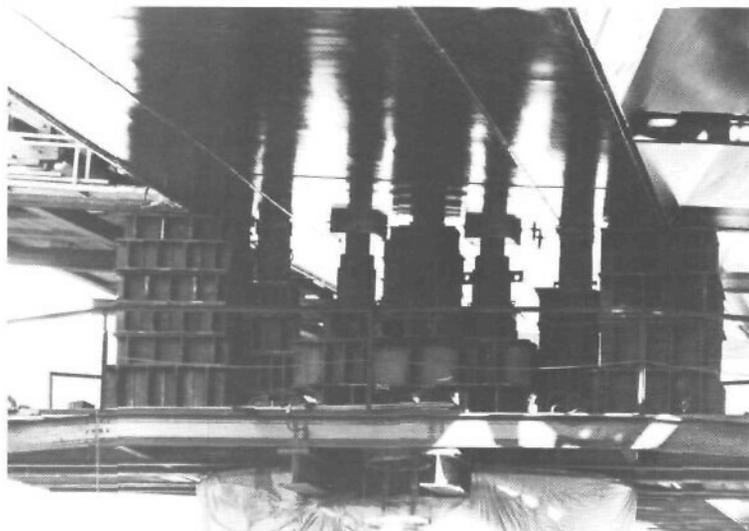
Équipement d'une tête de pile pour réaliser une dénivellation d'appui d'un caisson.
